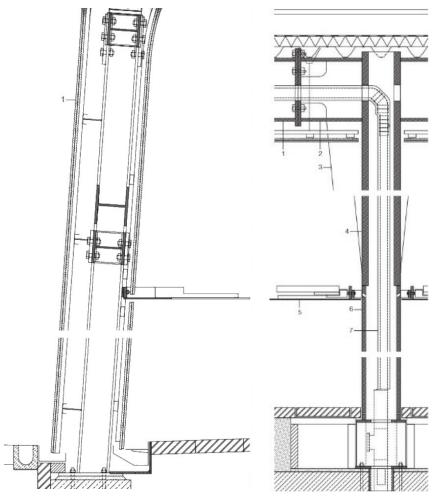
Detalles de arranque de estructura soporte y envolvente.
